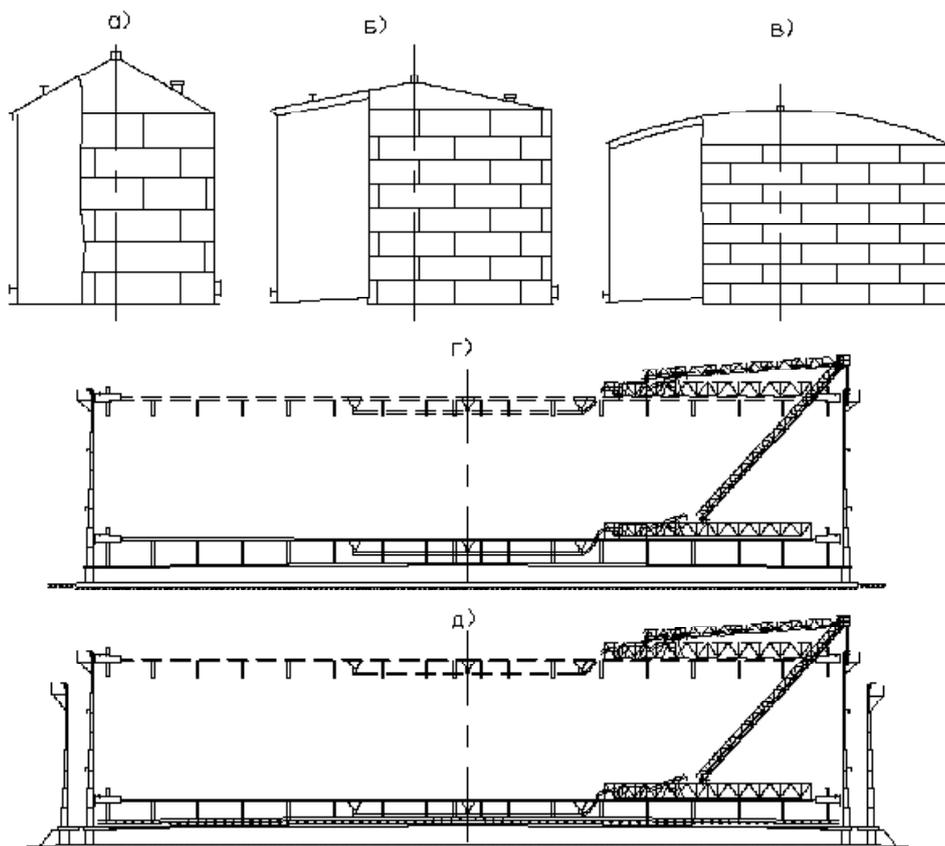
Типовые группы конструктивного исполнения резервуаров:
